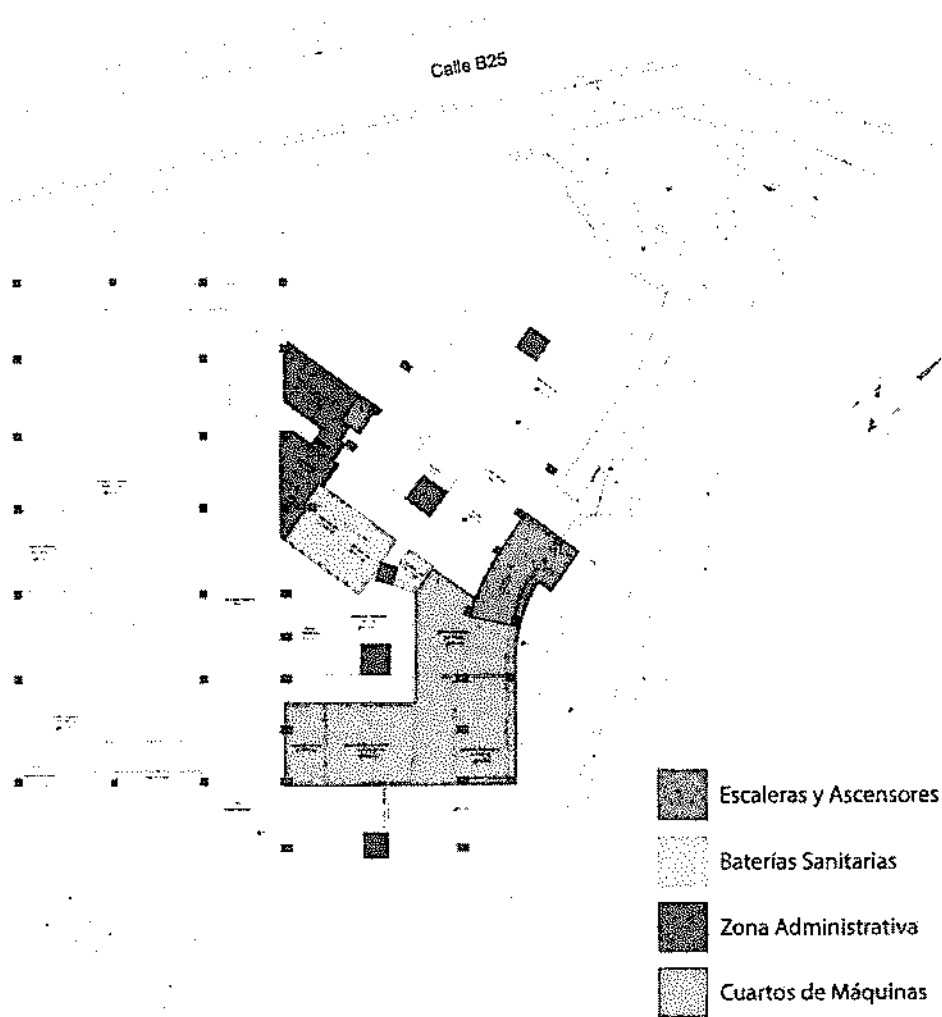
PLANTA ALTA COLINAS. Fuente: Consultor
